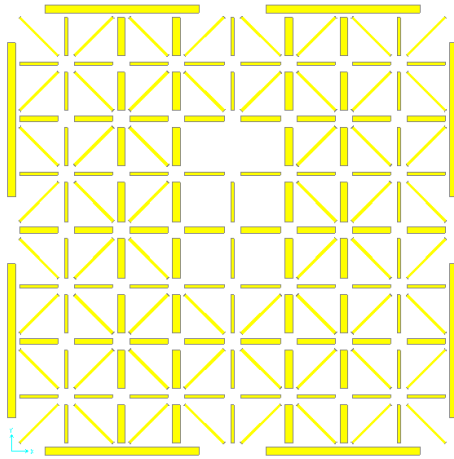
Parrilla metálica Piso 1 Acero - Escoria
